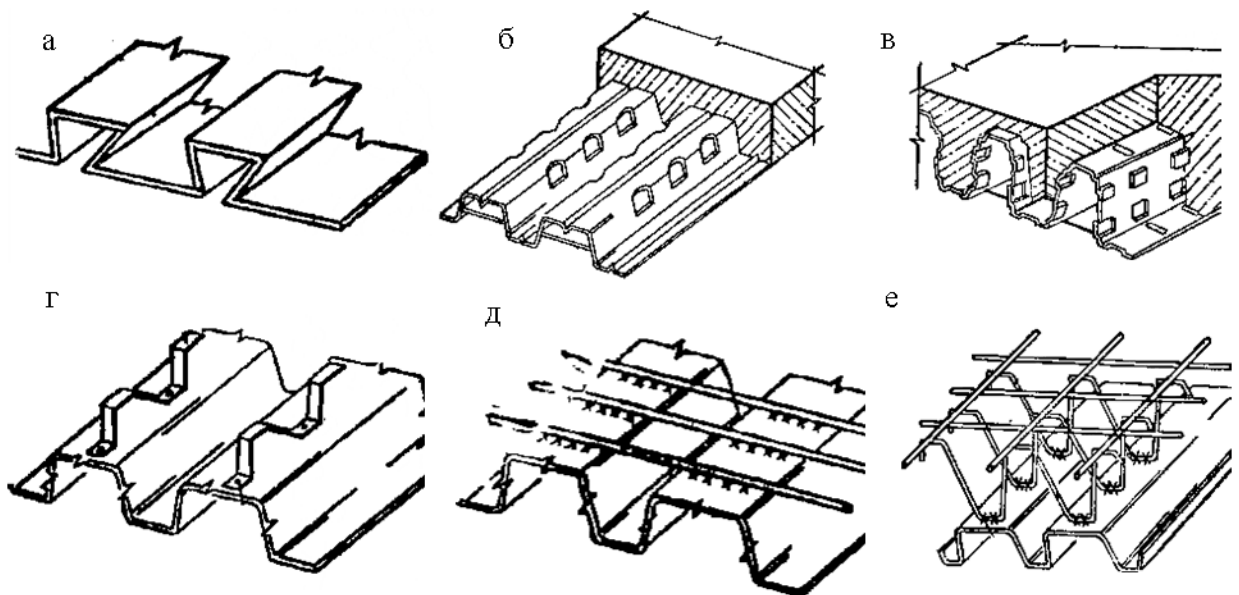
Способи анкерування профільованого настилу до монолітної залізобетонної плити: а) – за допомогою форми профіля; б) – за допомогою просічок; в) – за допомогою виштампувань; г), д), е) – за допомогою приварювання додаткових анкеруючих елементів
